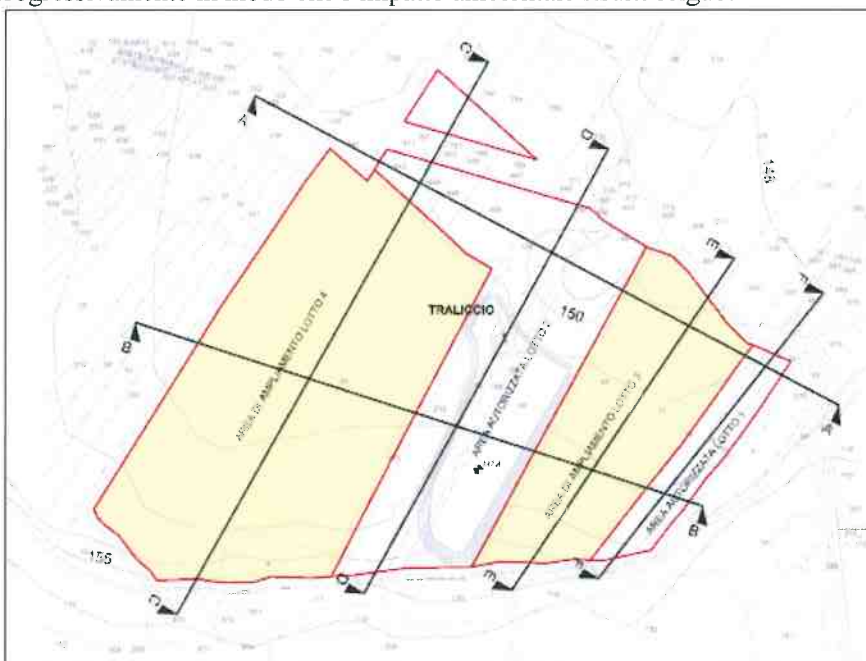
Planimetria stato attuale (da Tav. A allegata allo SPA)
